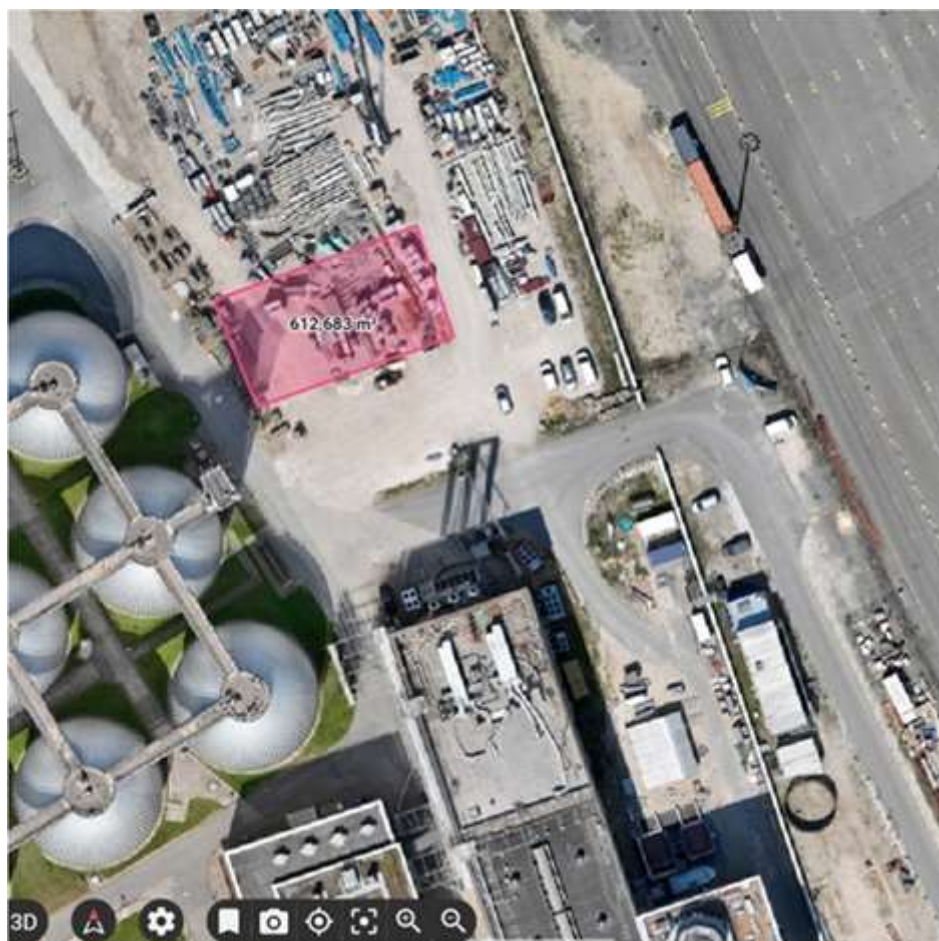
Lage der Baustelleneinrichtungsfläche
